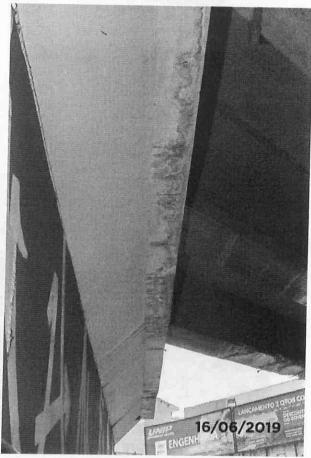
Armadura exposta na viga de travamento transversal sobre os pilares centrais.
